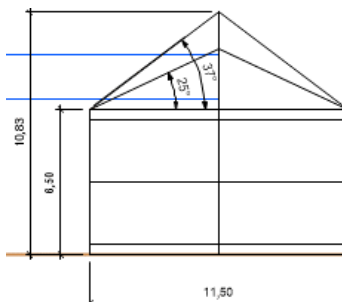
Wandhöhen und Dachneigungen im WA 1 und WA2
